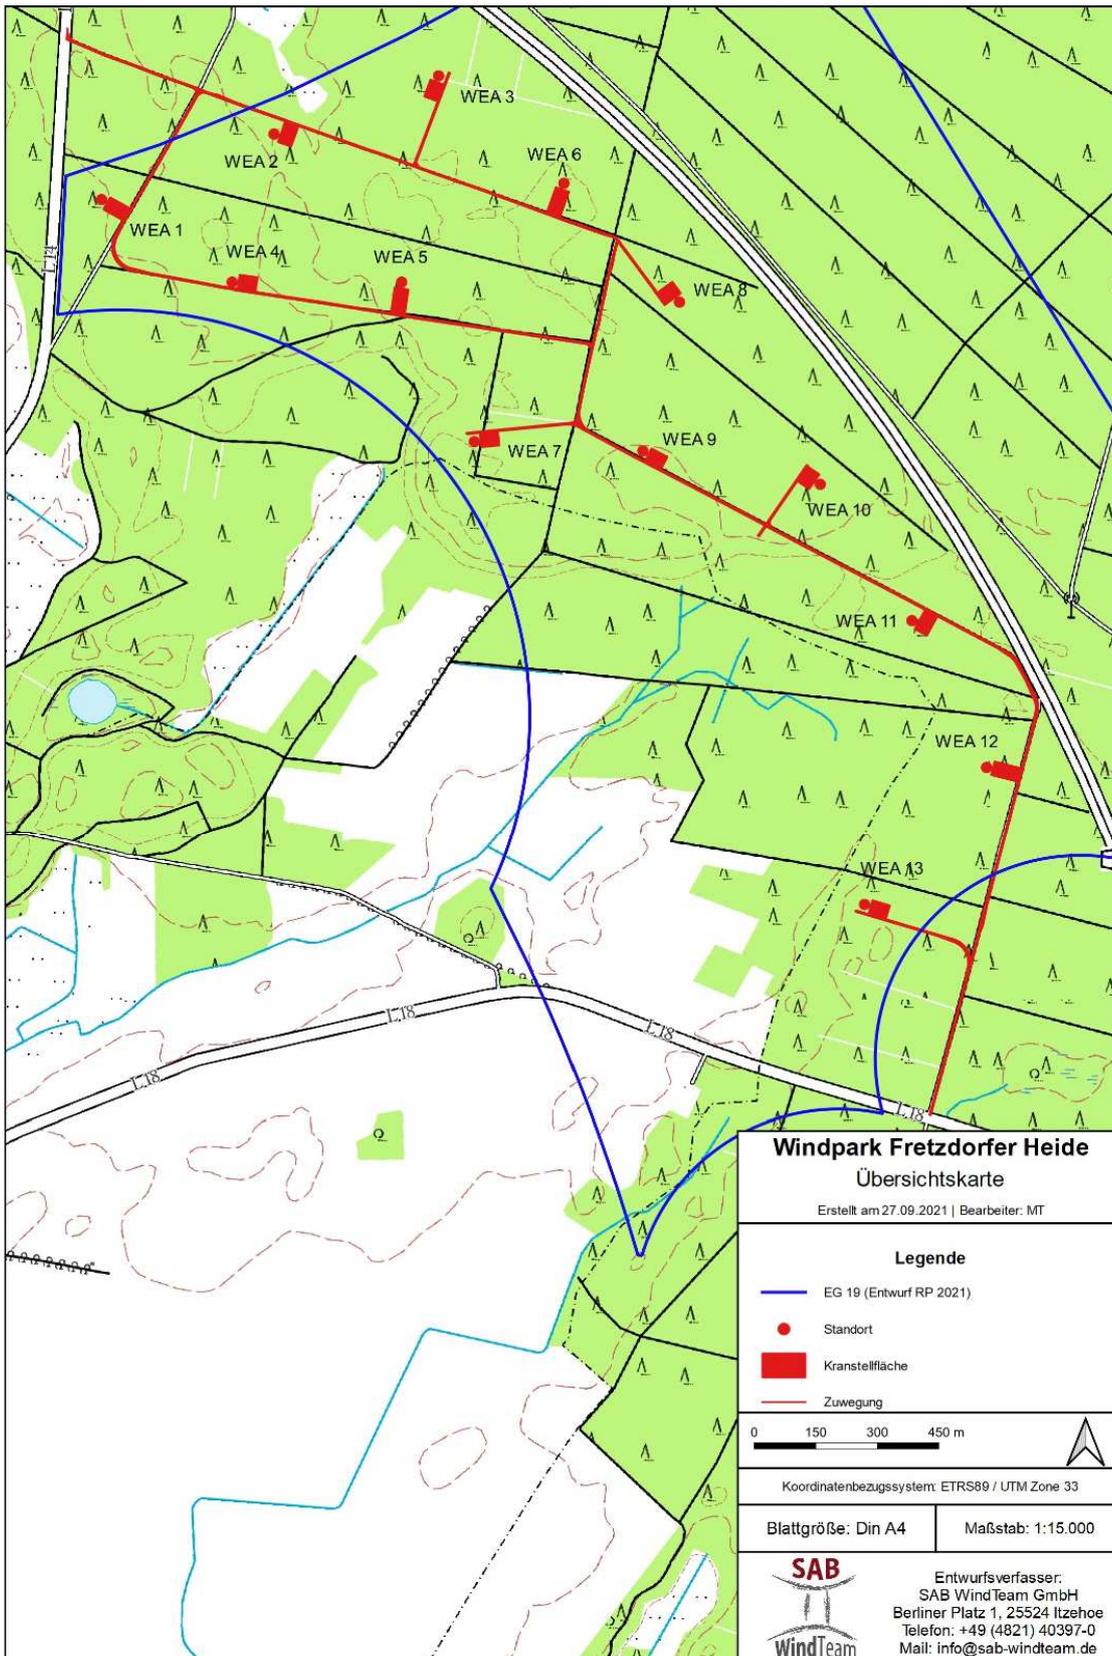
Lageplan WP Fretzdorfer Heide - Parkinterne Zuwegung, Nutzung vorhandener Waldwege
